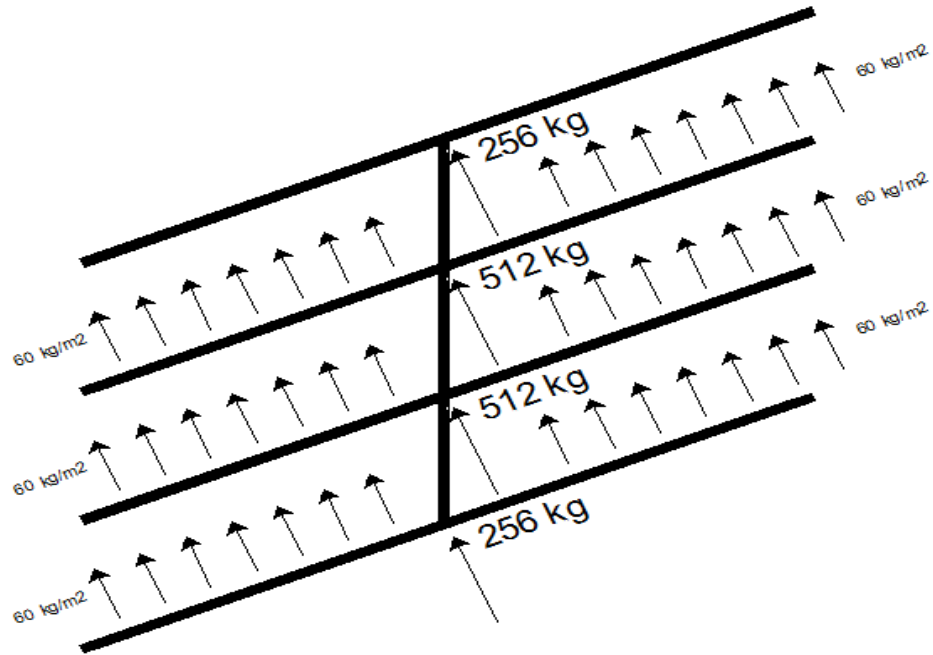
Esquema de cargas actuantes en columnas de estructura metálica.
